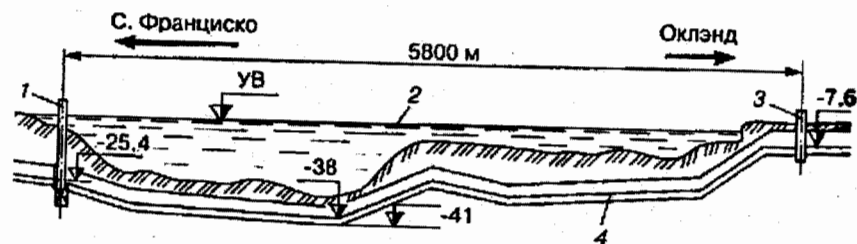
Железнодорожный тоннель под заливом Сан-Франциско: 1 – вентиляционное здание на кессоном фундаменте, 2 – средний уровень моря, 3 – вентиляционное здание, возведённое в открытом котловане, 4 – уровень рельса
